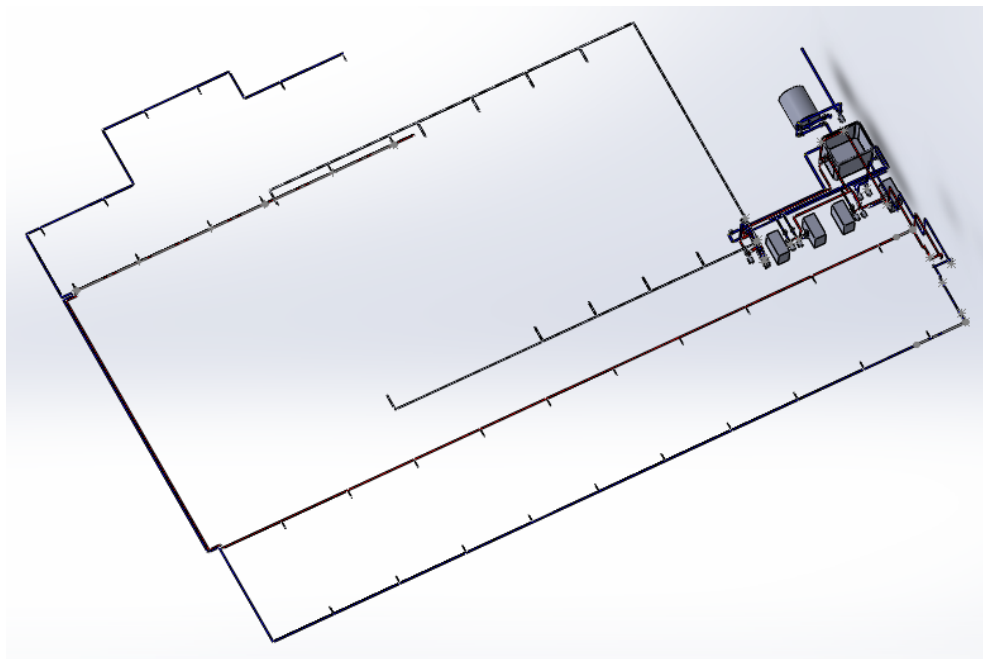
CAD de la planta alta elaborado en Solidworks. Autor
